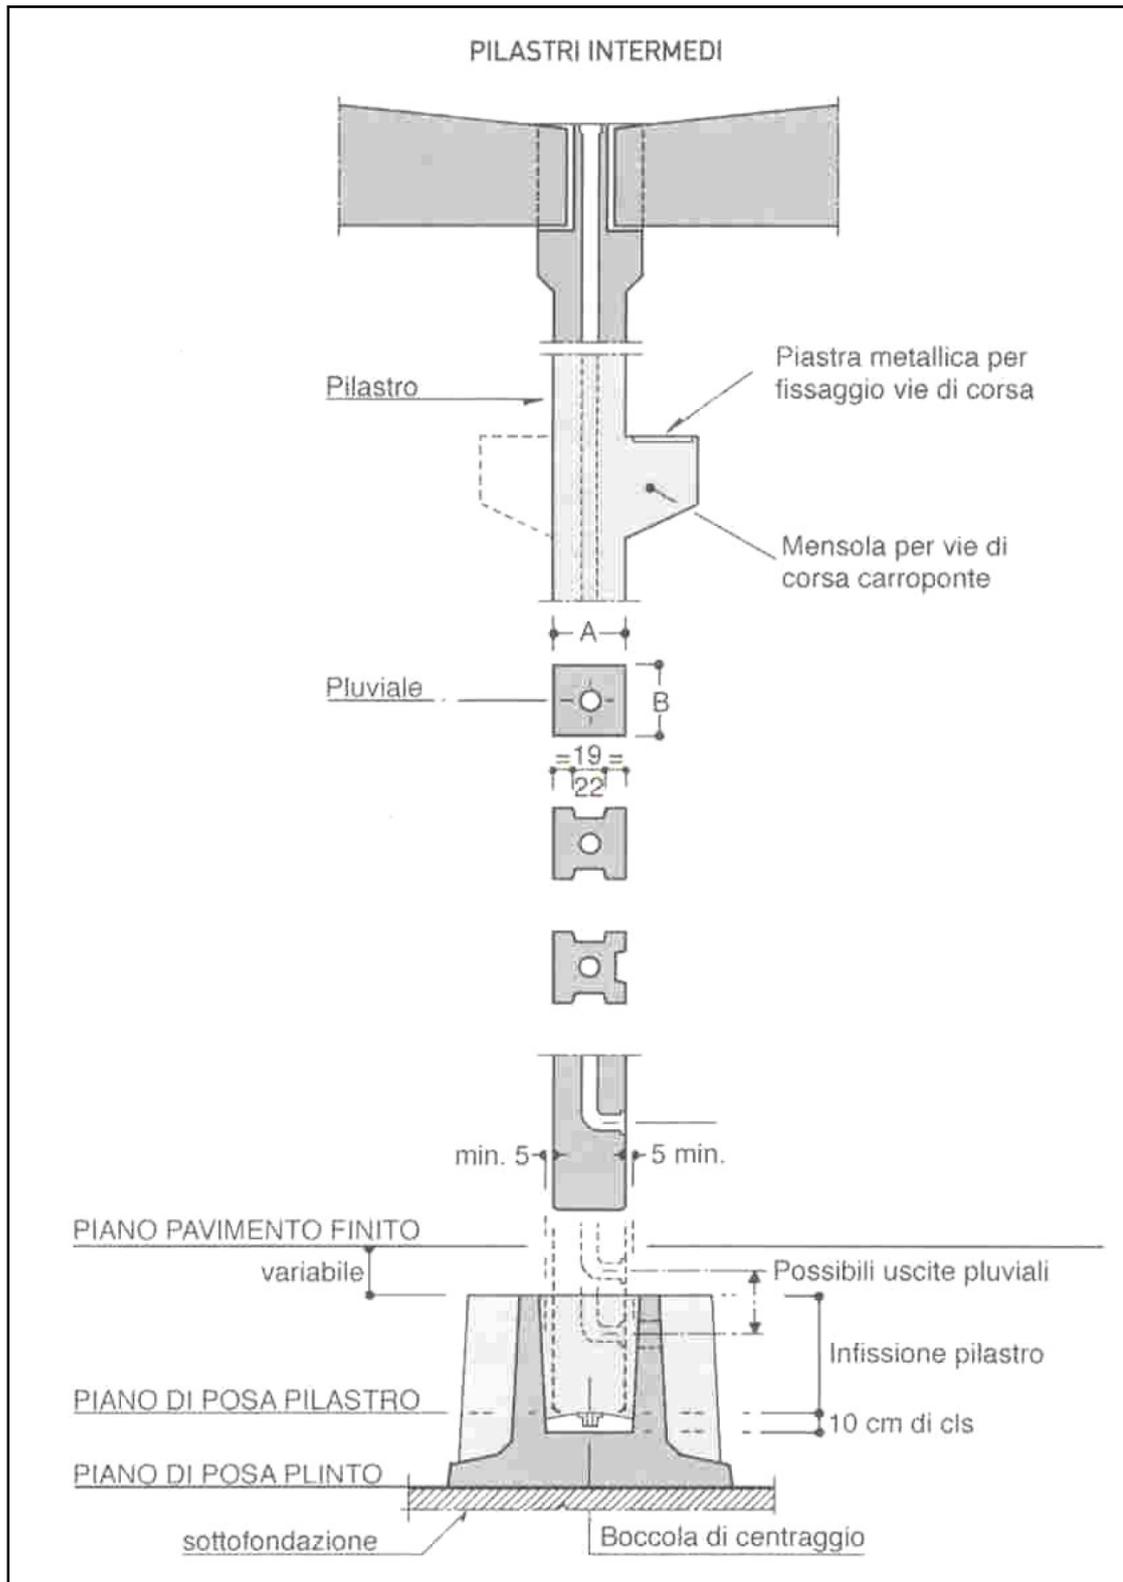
Sistemi di copertura piana in cemento armato precompresso
